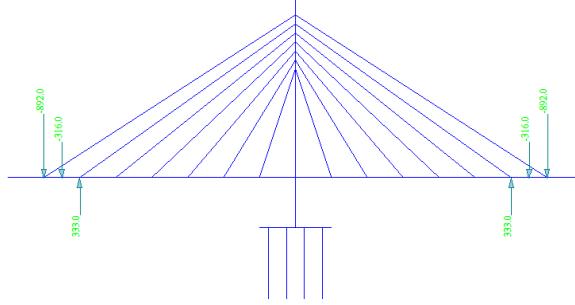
41 Permodelan saat Construction Stage 1 (CS 1)
